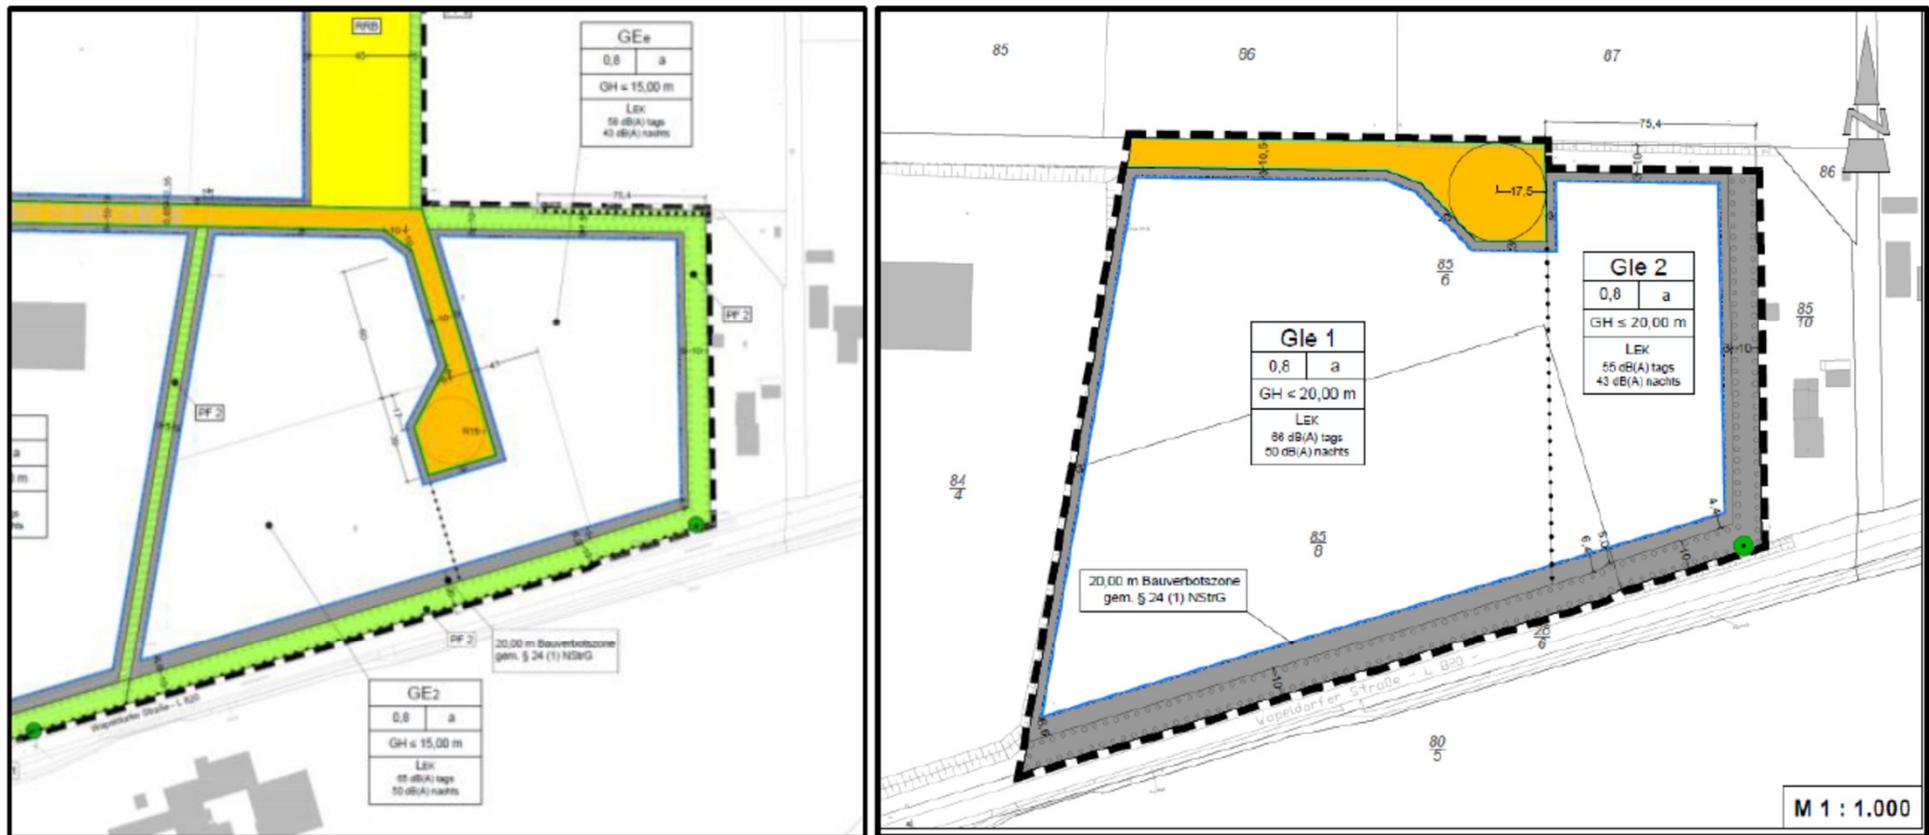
Bestehender B-Plan (links) und Inhalt der 1. Änderung (rechts)
